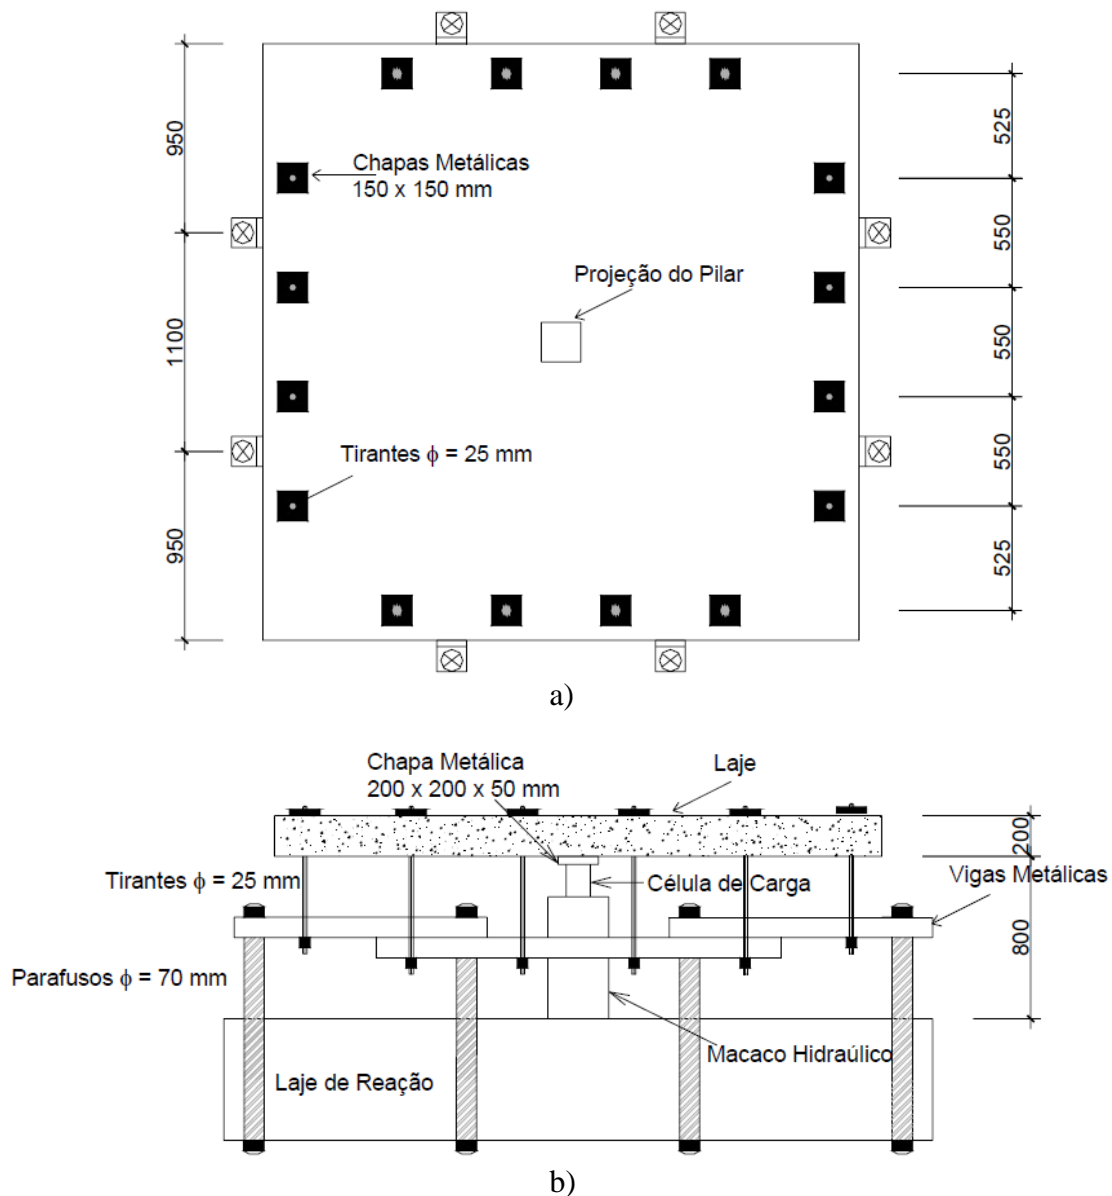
Sistemas de ações e reações das lajes utilizadas pelo pesquisador, a) Em planta, b) Em perfil.
